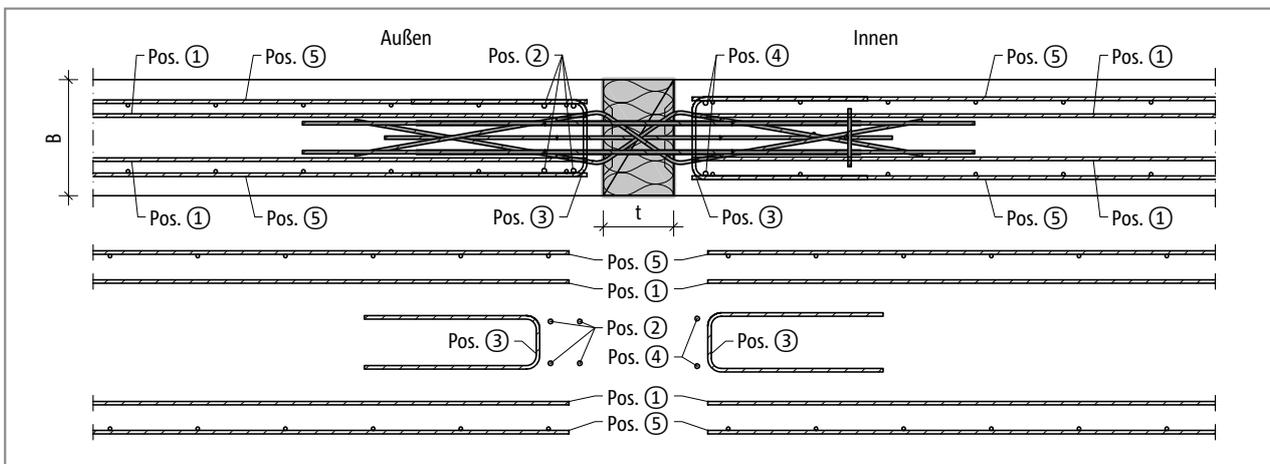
Schöck Isokorb® Typ WXT: Bauseitige Bewehrung; Grundriss
